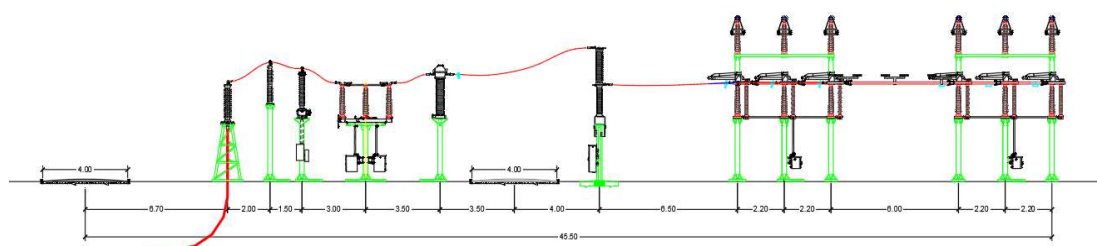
sezione futuro stallo di arrivo in Stazione Elettrica RTN
